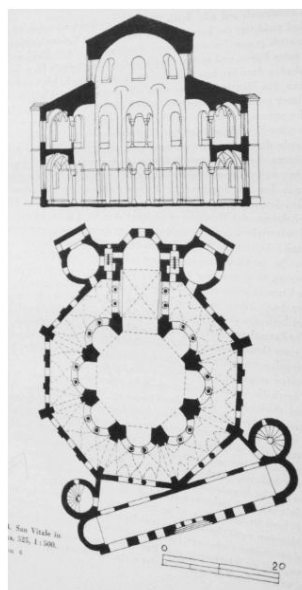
Auf- und Grundriss, San Vitale, Ravenna, zweites Viertel 6. Jh.
